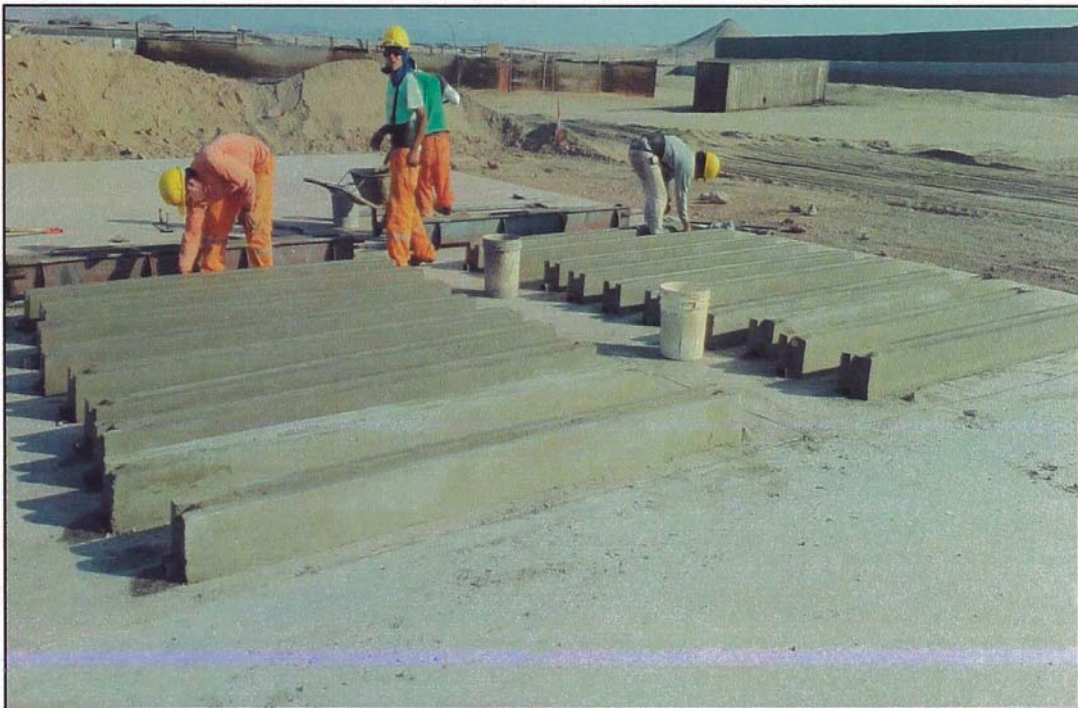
Fabricación de Columnas – solaqueo de columnas
